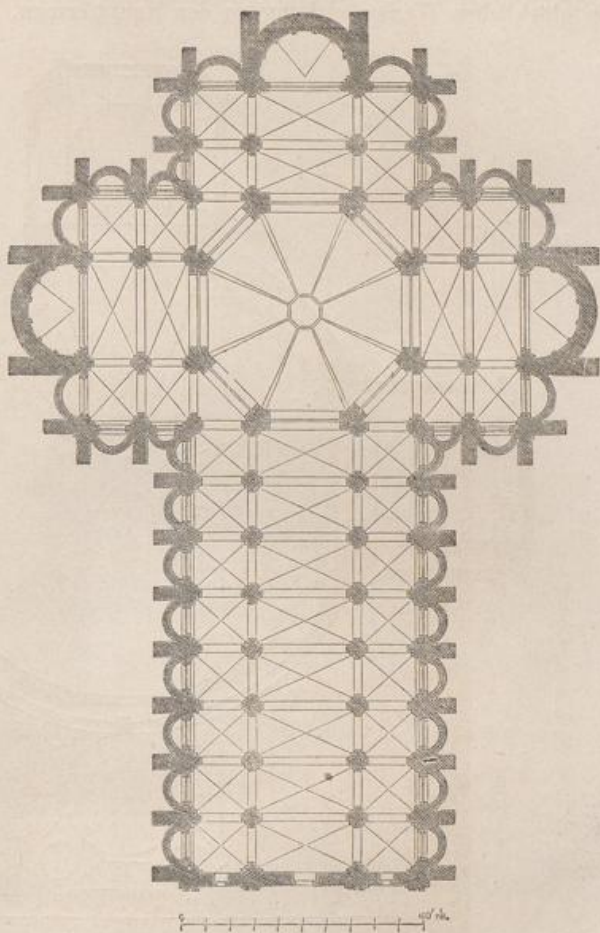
Dom zu Pavia. Grundriss.
